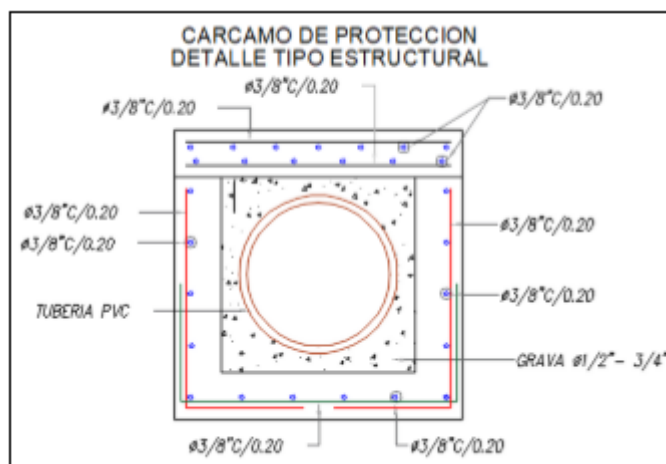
Esquema de para el paso de la tubería de alcantarillado bajo la quebrada El Rey
